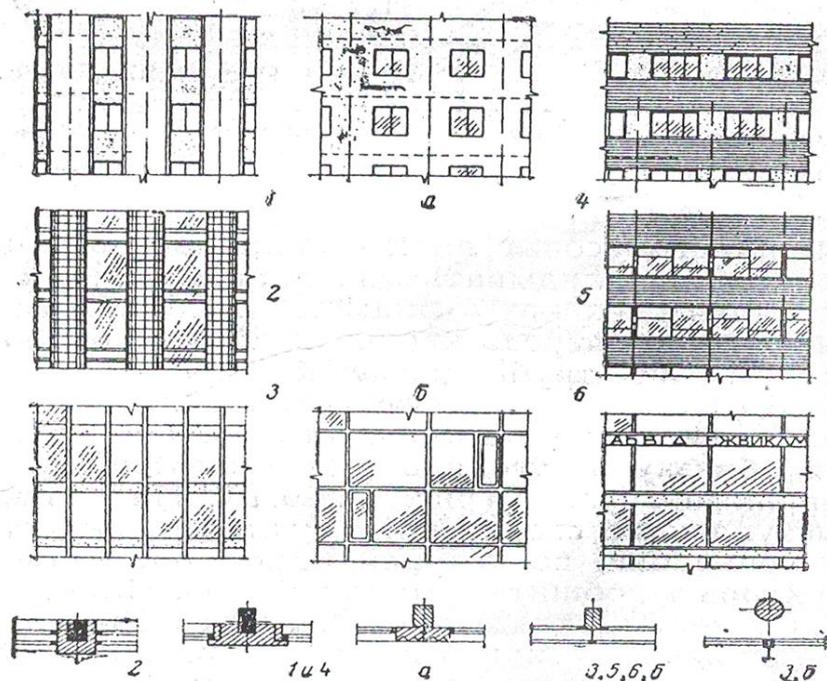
Схемы фасадов многоэтажных зданий с навесными несущими стенами
